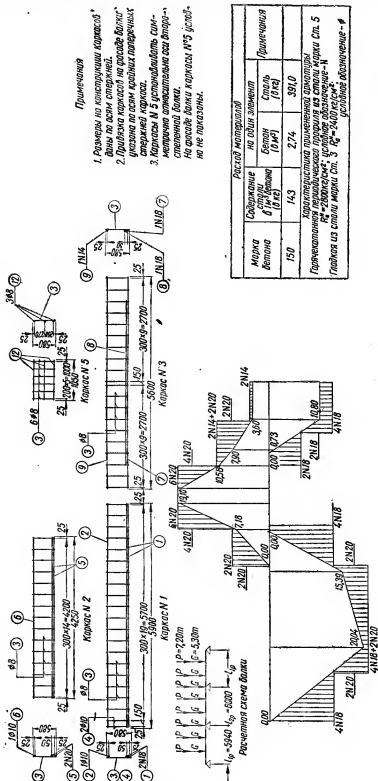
Конструкция главной балки, армированной сварными каркасами.
